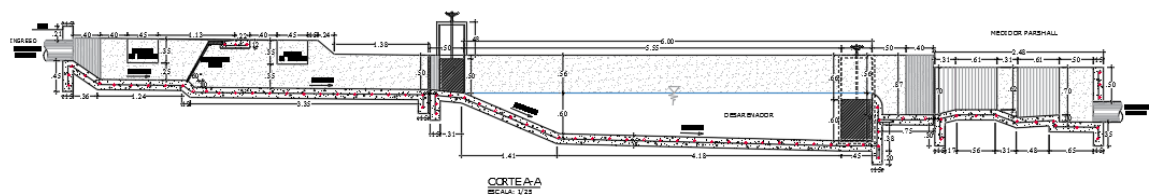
Diseño en Alzado Cámara Rejas-Desarenador-Parshall
